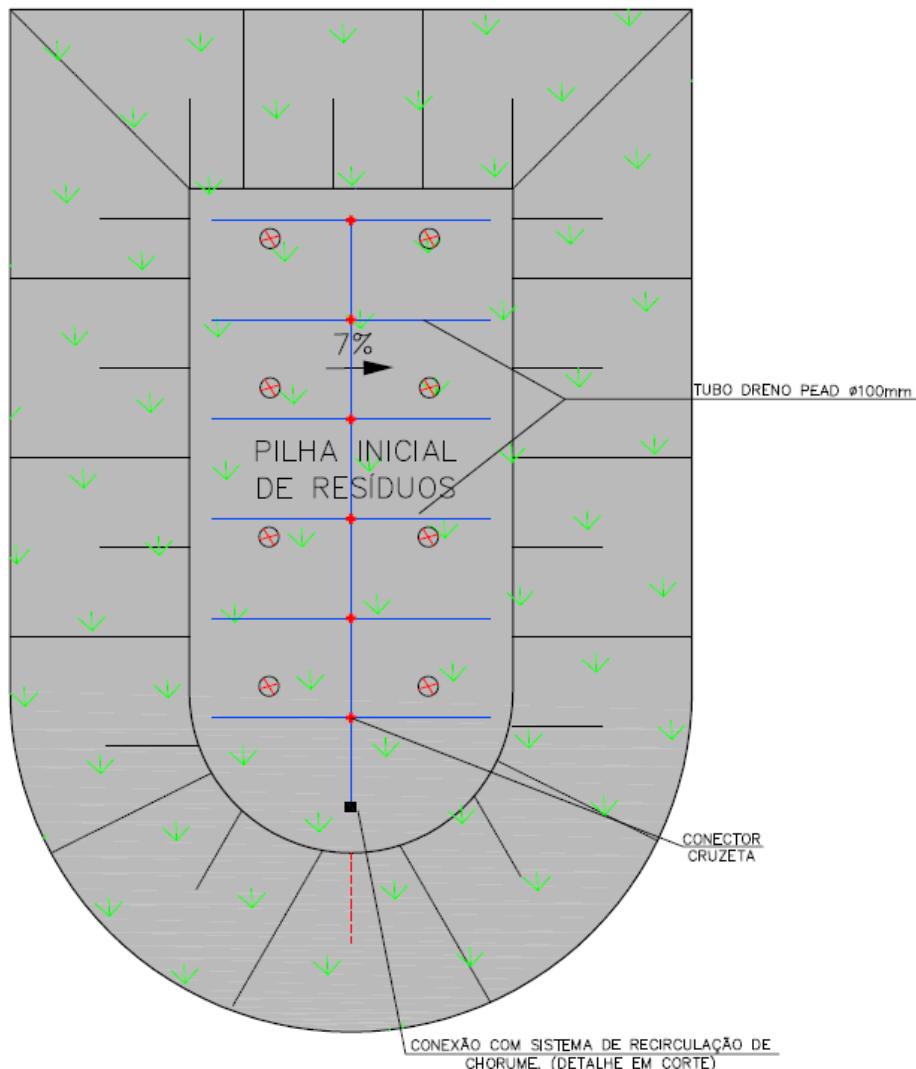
Disposição típica da tubulação do sistema de recirculação de chorume.
